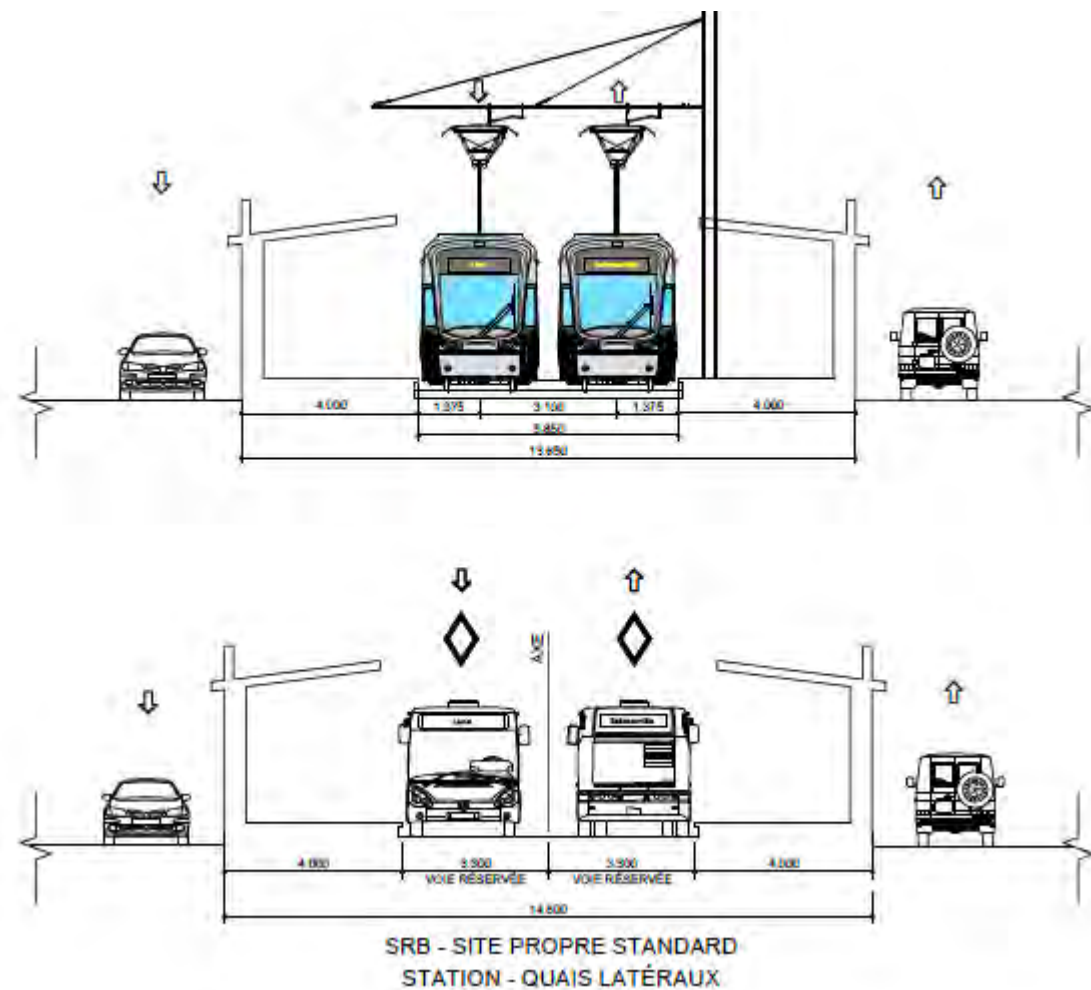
Coupe type 06 de 15 - SRB - Site propre standard - Station avec quais latéraux
